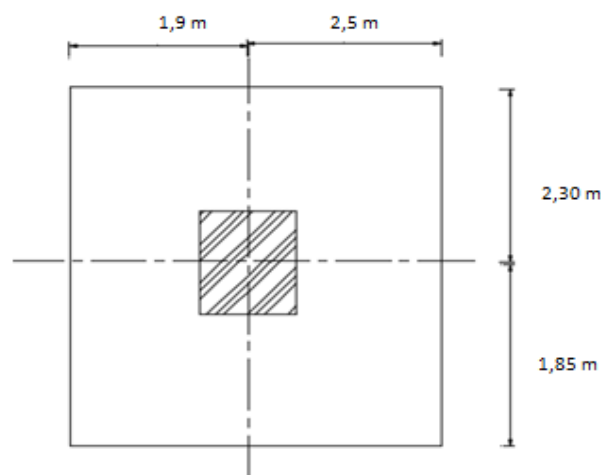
Section supportée par le poteau le plus sollicité.
